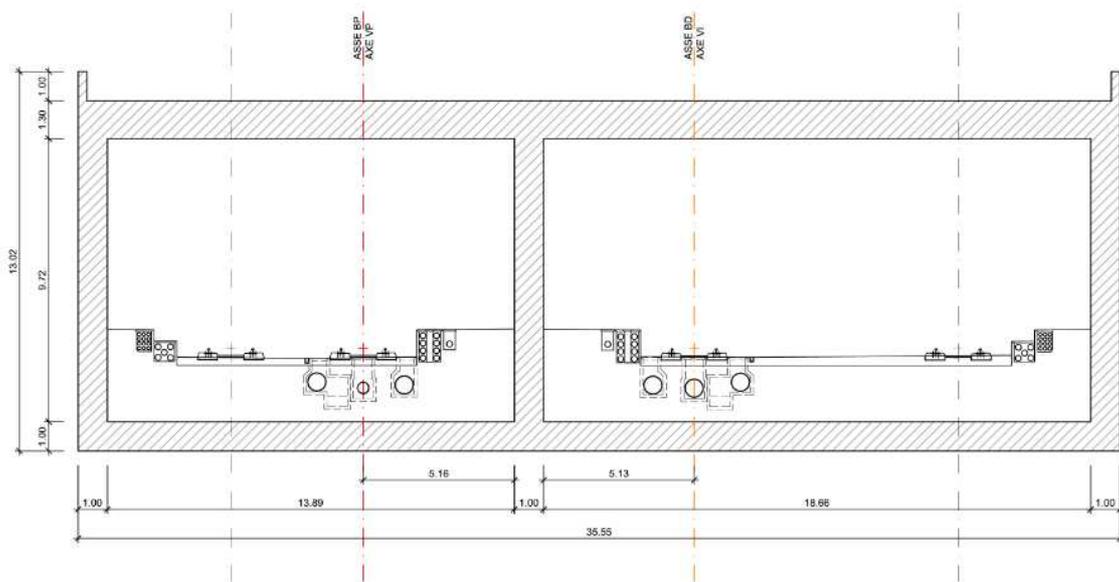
Sezione tipo galleria artificiale BP pk 61+076 – 61+084
